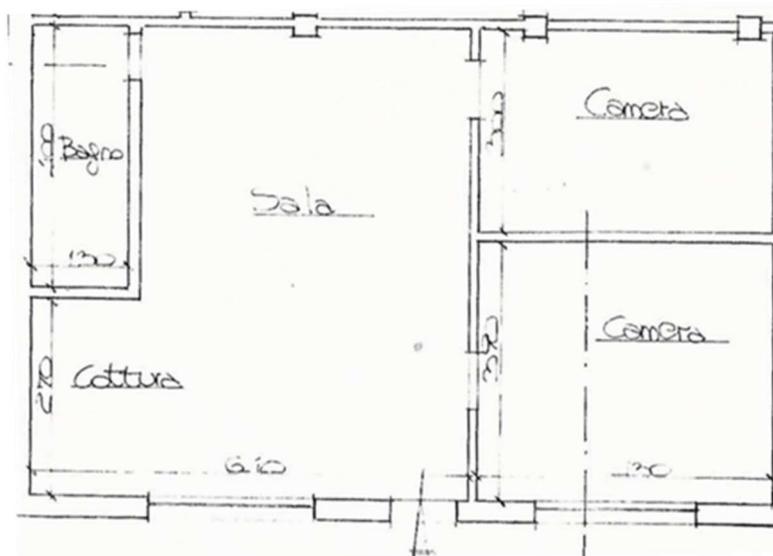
PLANIMETRIA DELL'APPARTAMENTO
